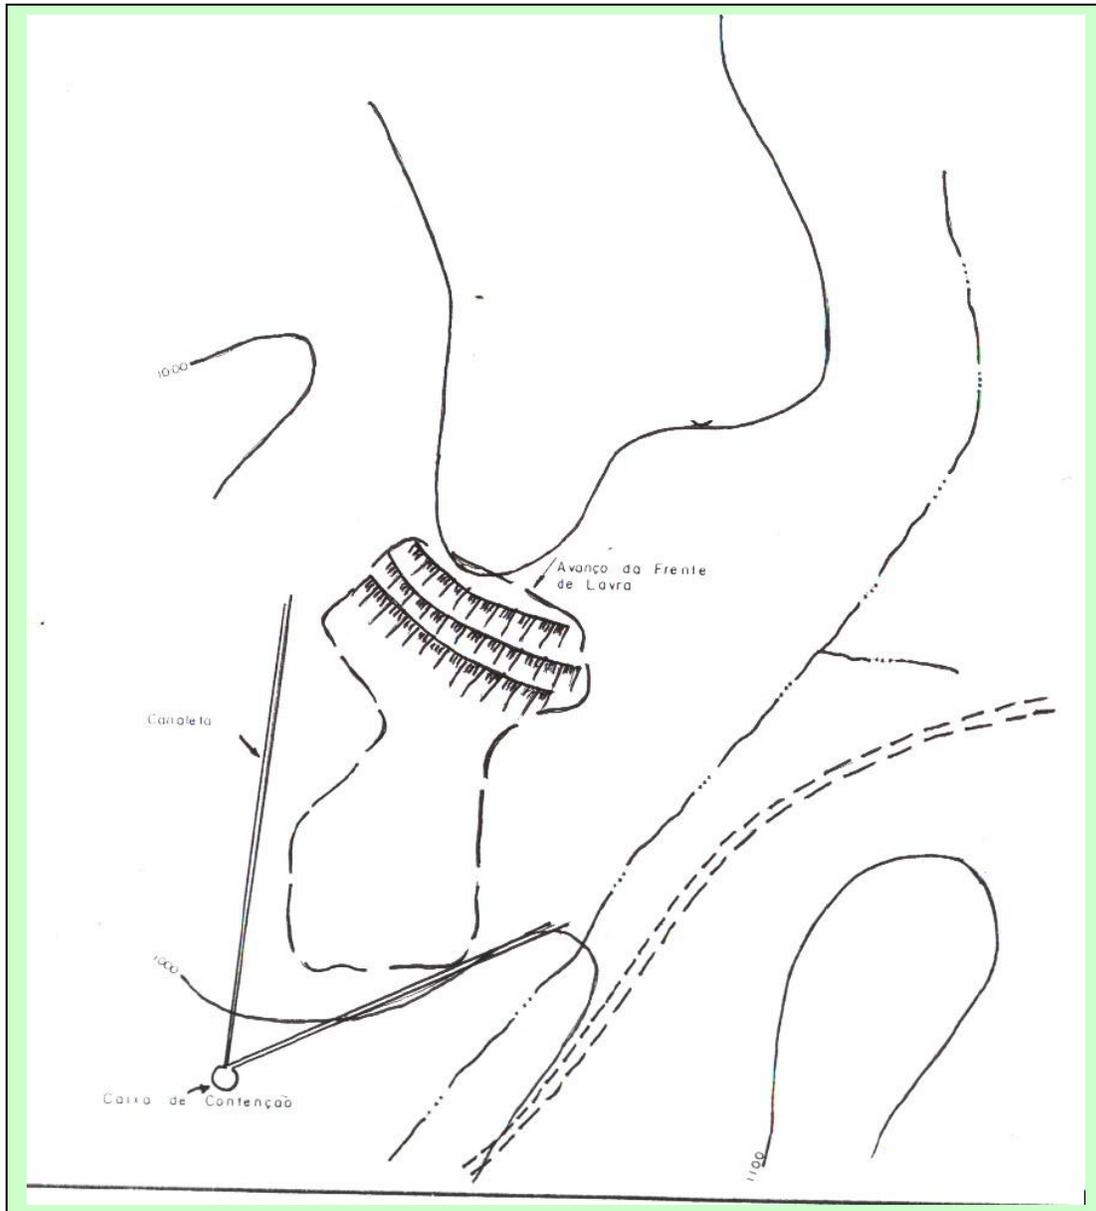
Infra-estrutura projetada para a área 365 – Área de Intervenção
